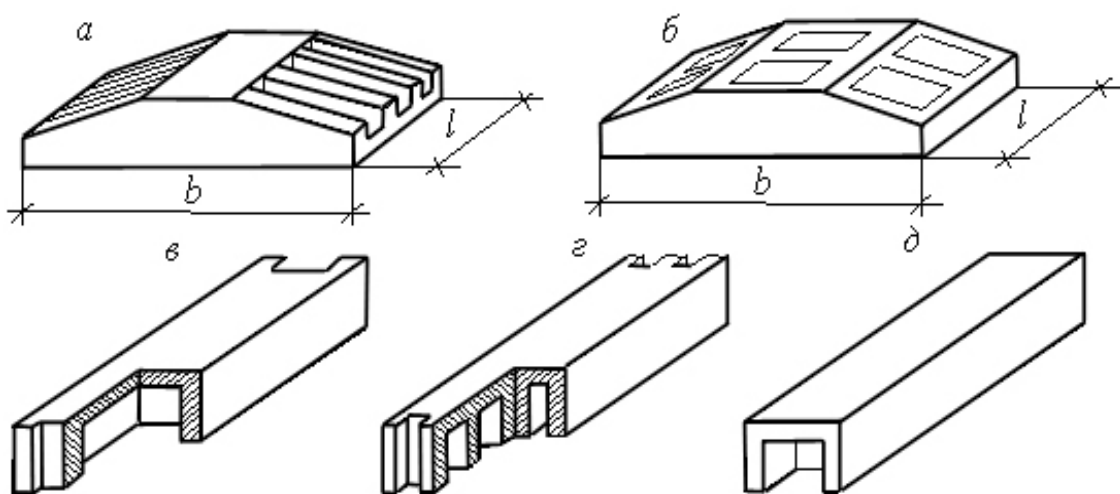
Облегченные элементы сборных ленточных фундаментов:
